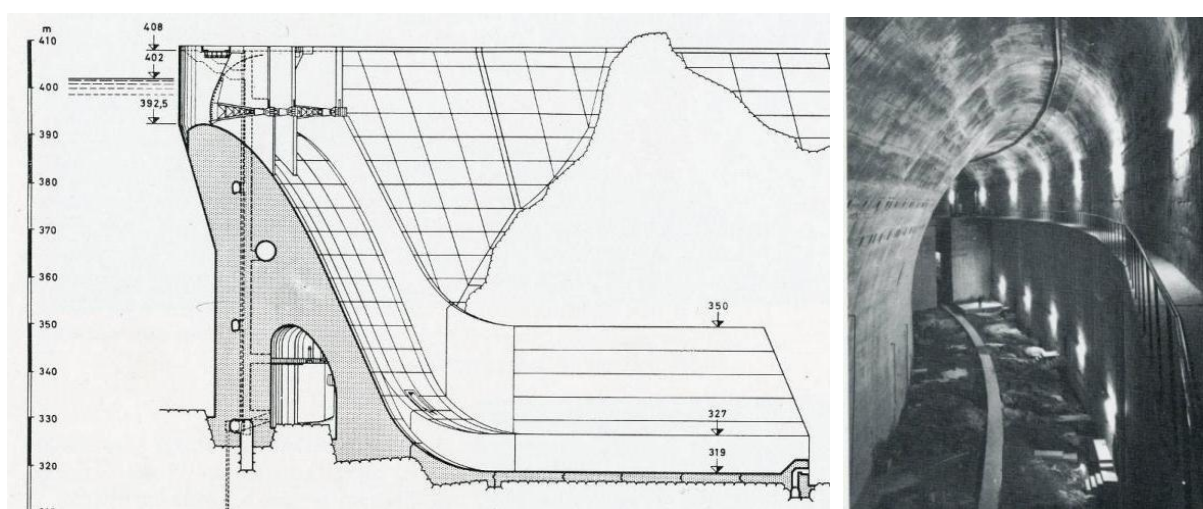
Vista da galeria e secção devidamente cotada da barragem de Bemposta (Portugal, 1964)
